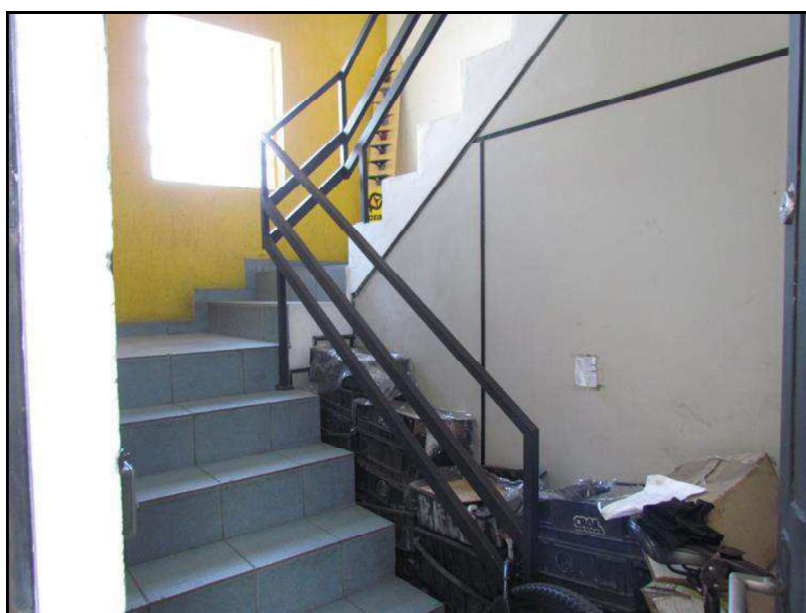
Vista da escada de acesso ao 1º pavimento.
